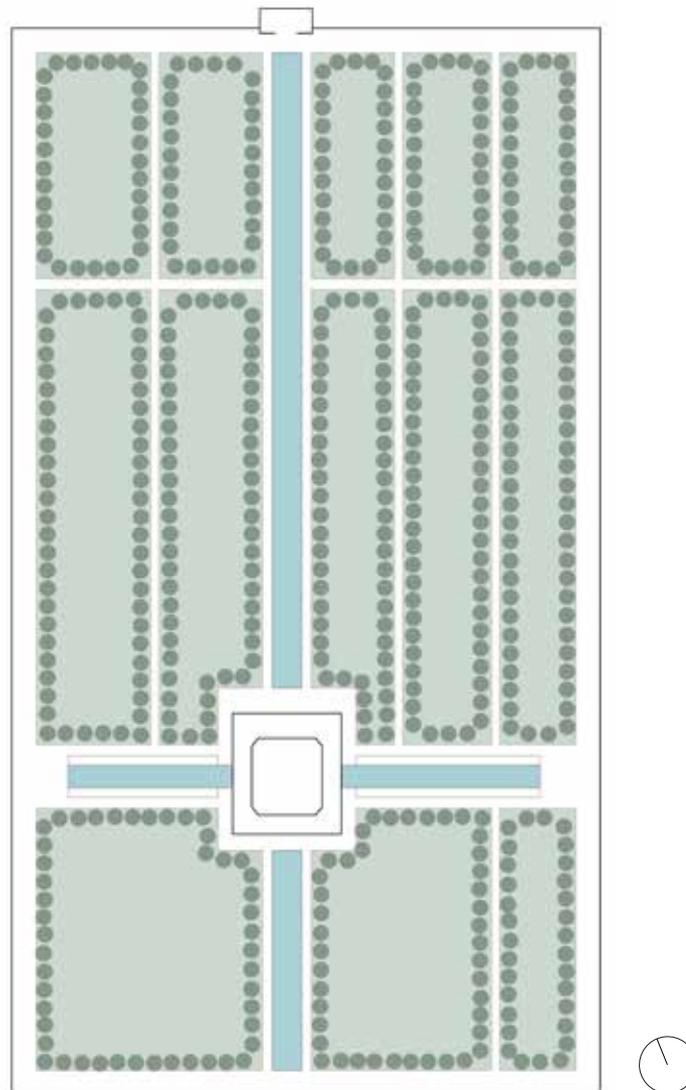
Grundriss des Hasht Behescht-Gartens in Isfahan.
